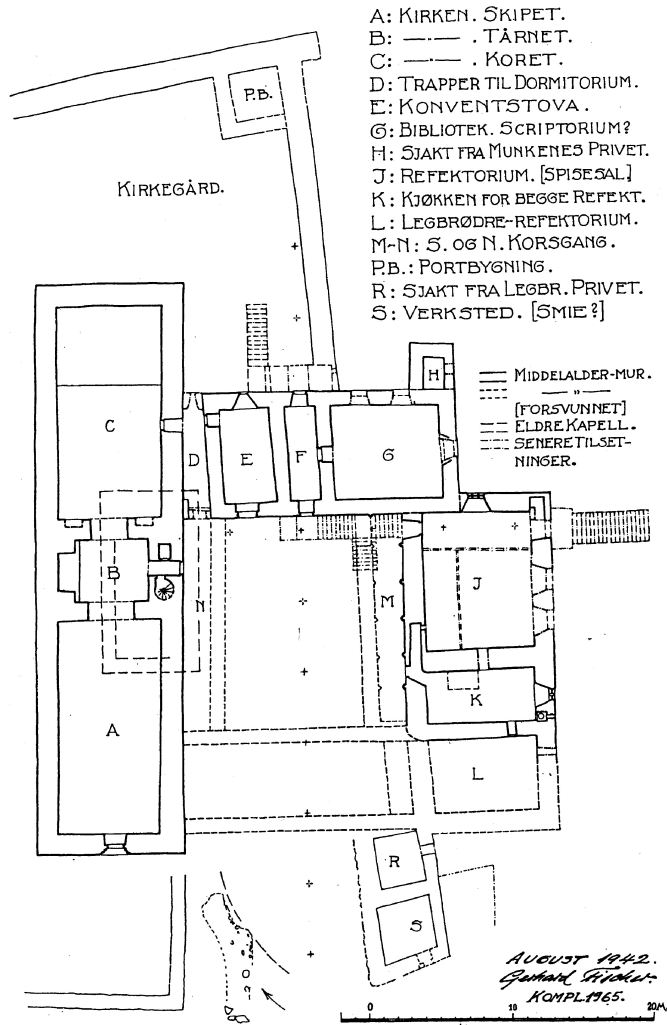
Utsteinklosterets grunnplan. Gjengitt etter Fischer 1965:7.
